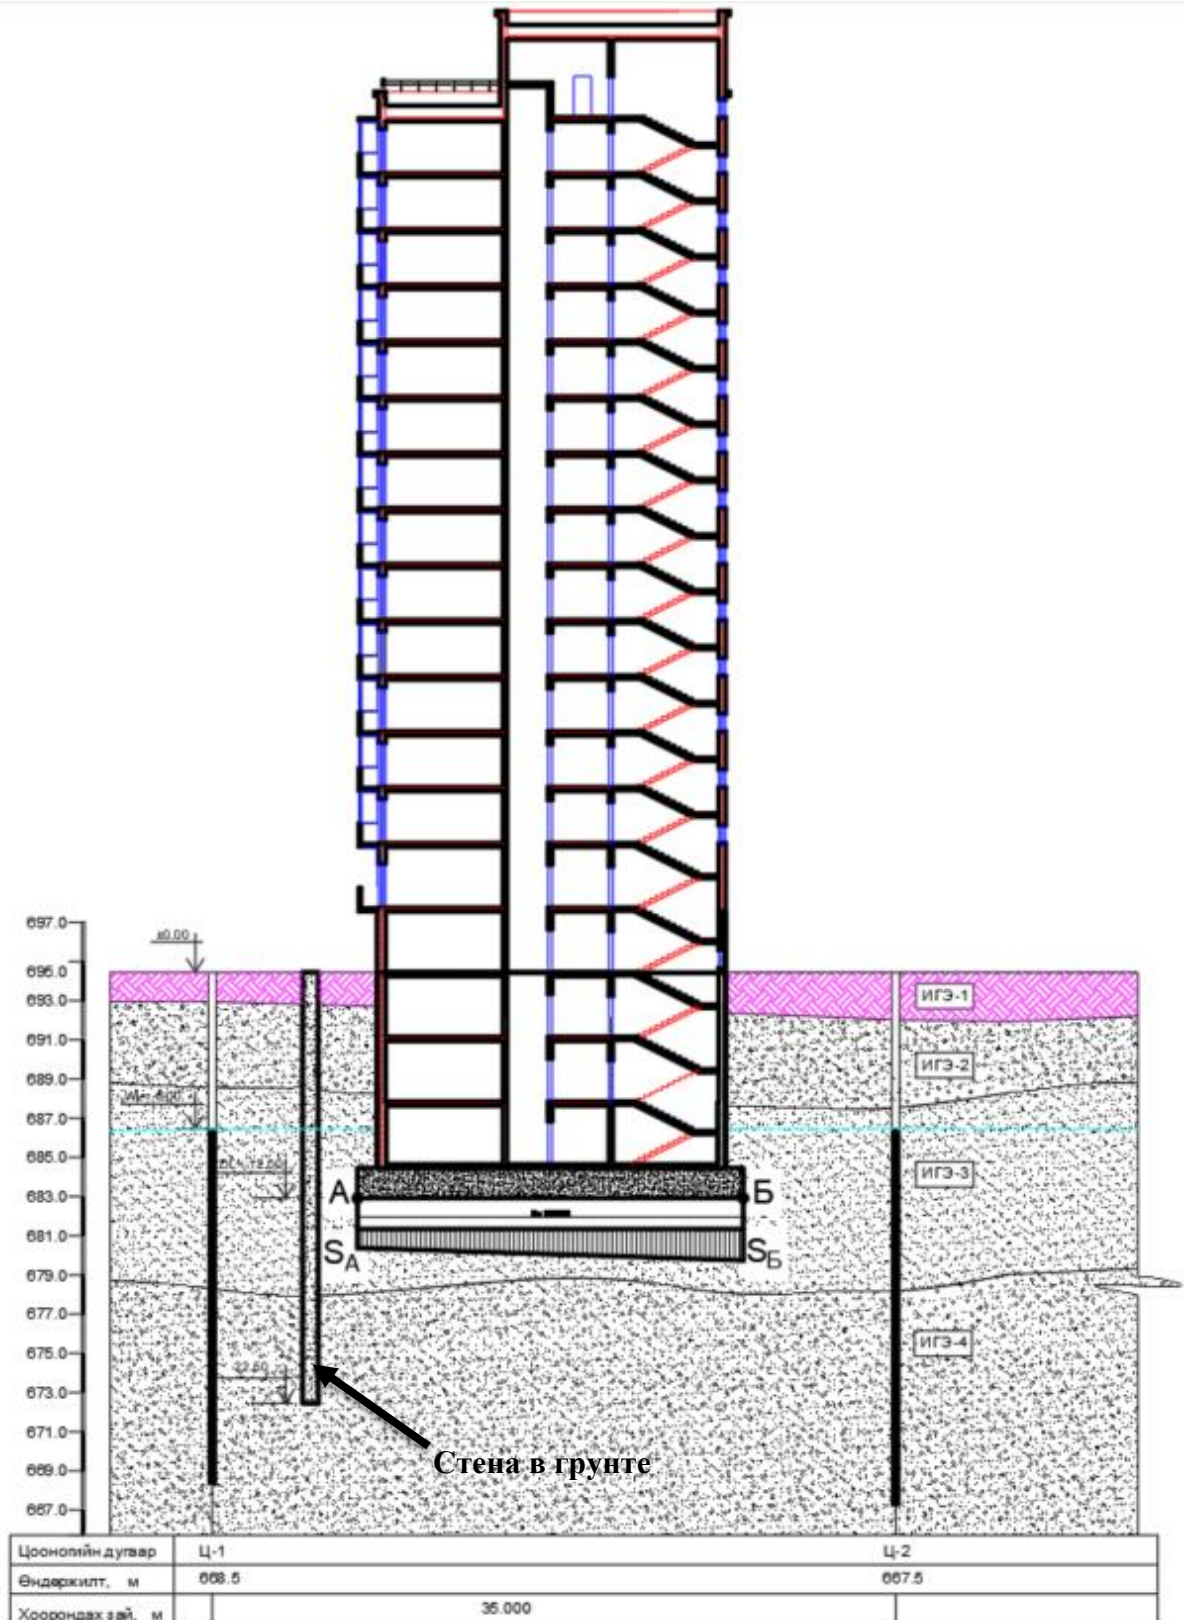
Поперечный разрез здания и геологическое строение строительной площадки
